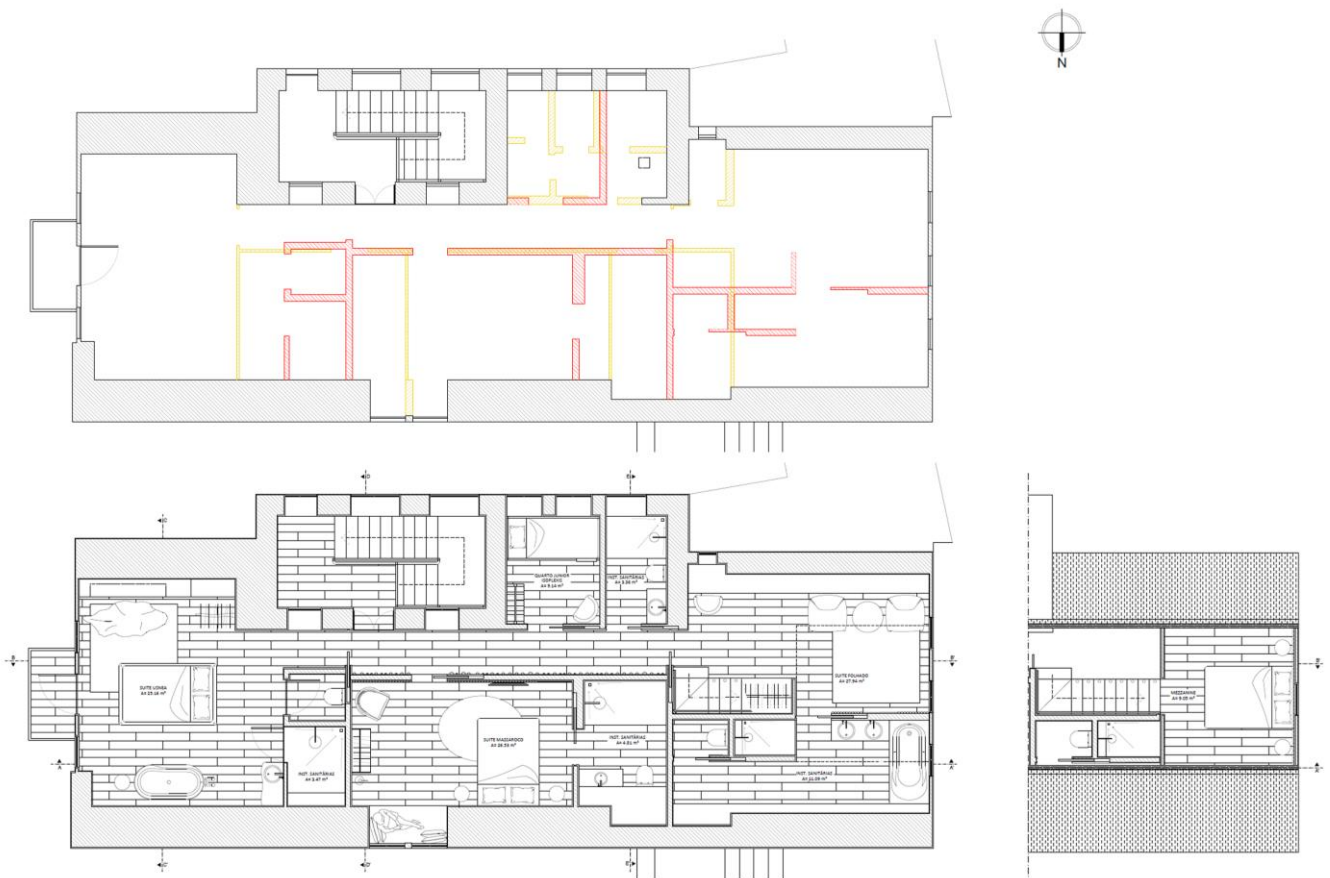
Planta de Alteração e Planta de Apresentação, Alojamento Loureiro Piso 1 e *Mezzanine*.
